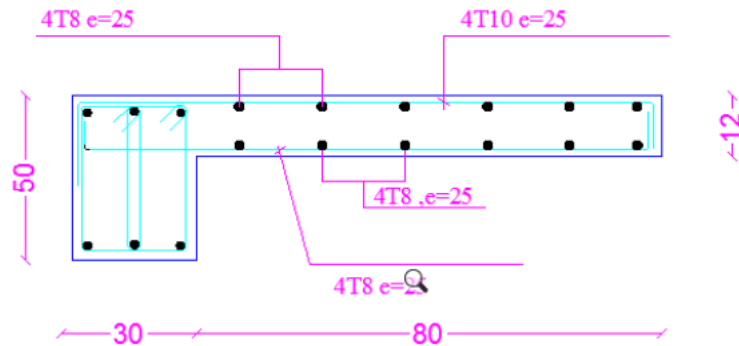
ferrailage du balcon type 2 (terrasse).
